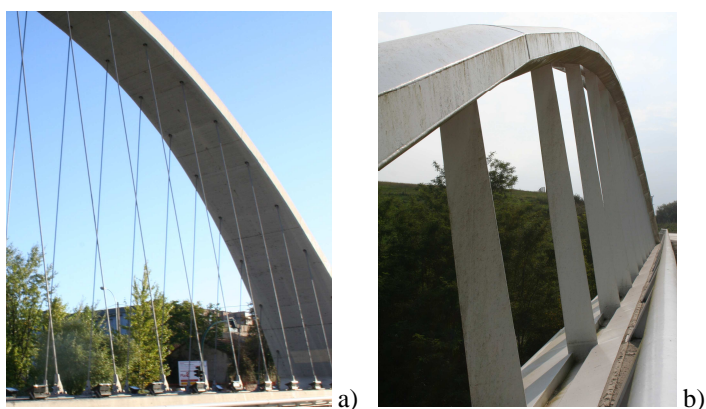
Elementi di sospensione: a) cavi; b) piastre.
